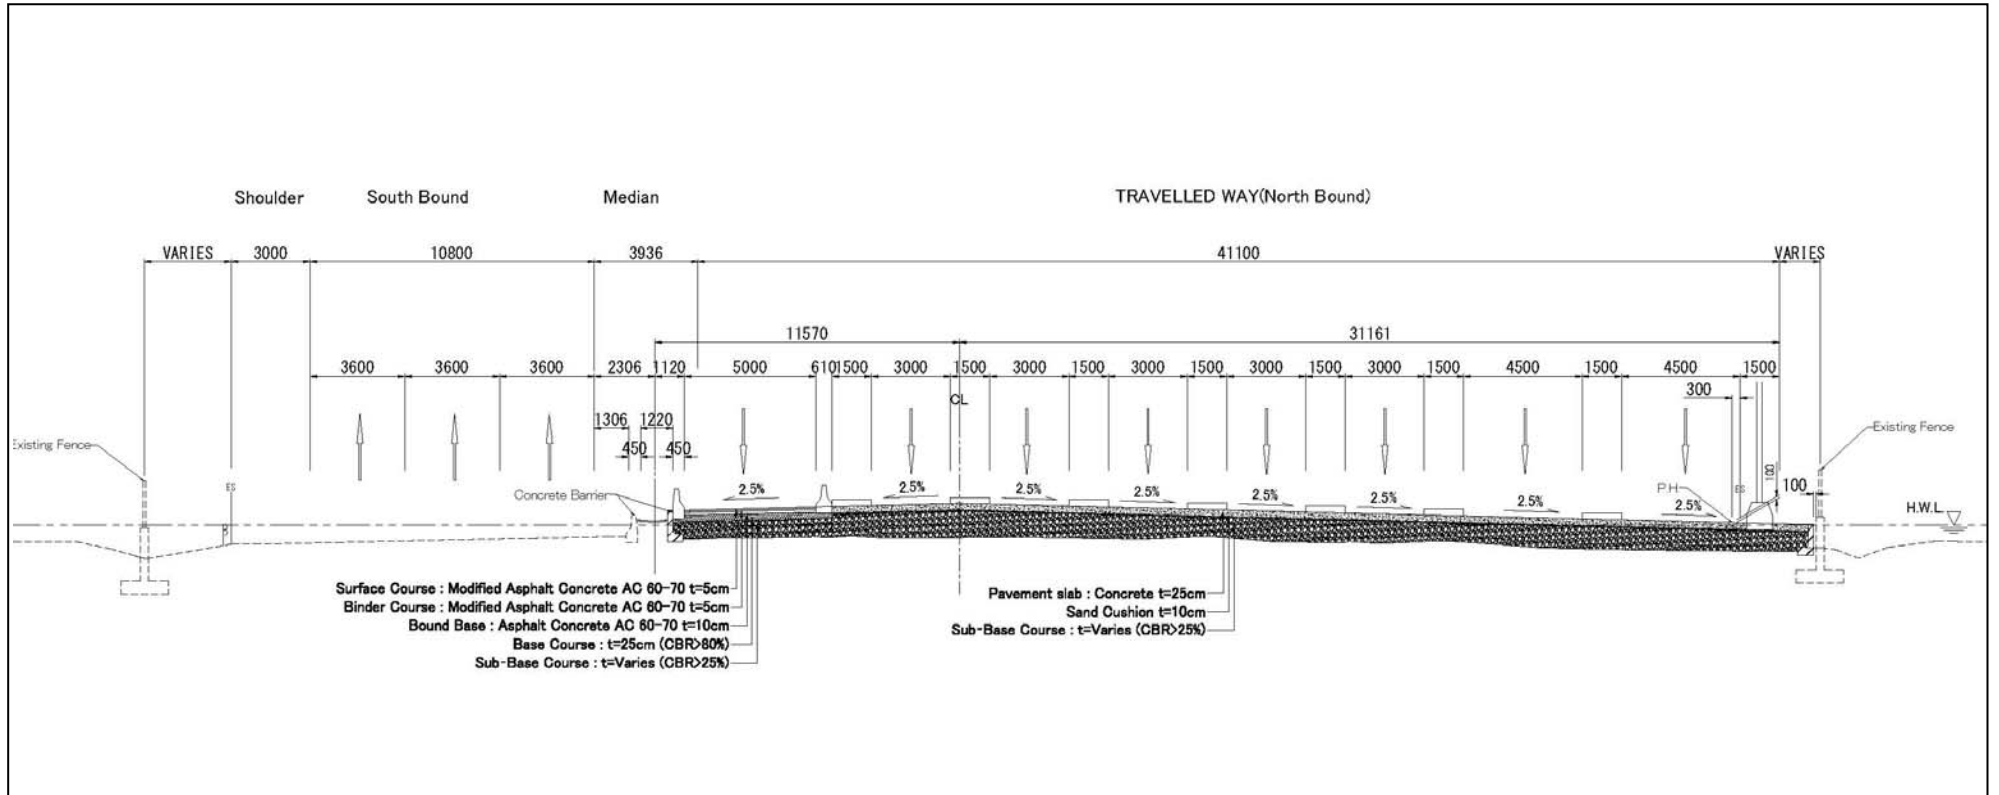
標準横断面図 (料金所区間の標準横断面図)
